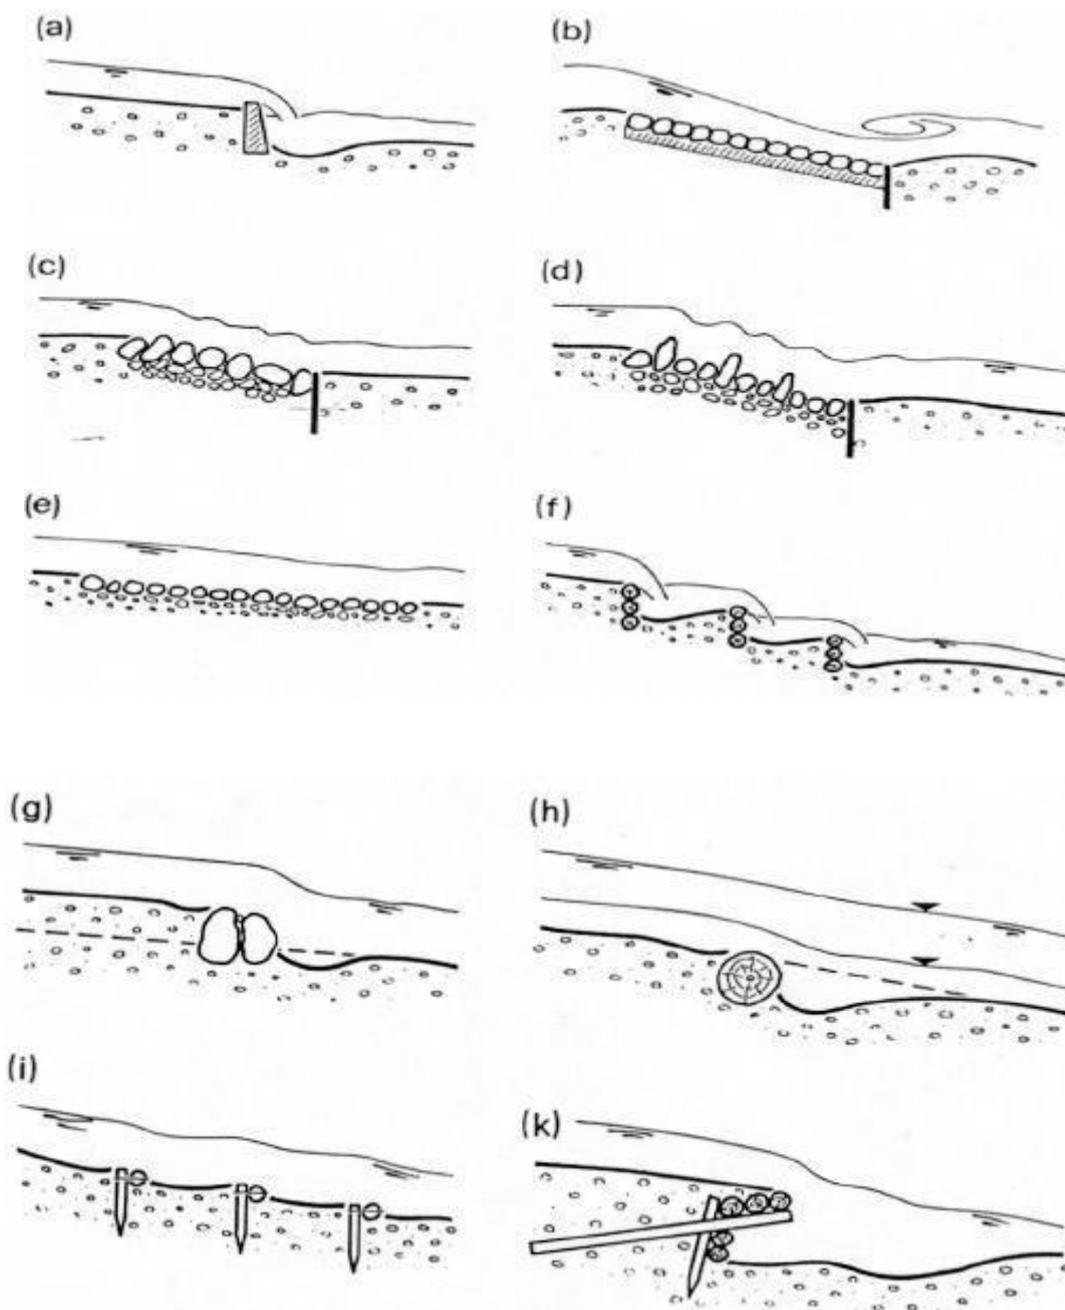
Les ouvrages transversaux : a) Seuil b) Coursier bétonnier c) Rampe des blocs
